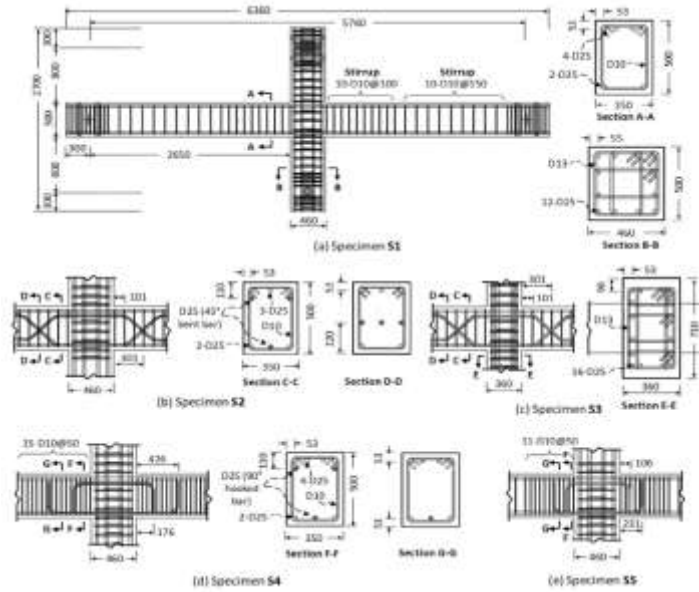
Detalle del reforzamiento de junta viga de sección variable-columna [39].
